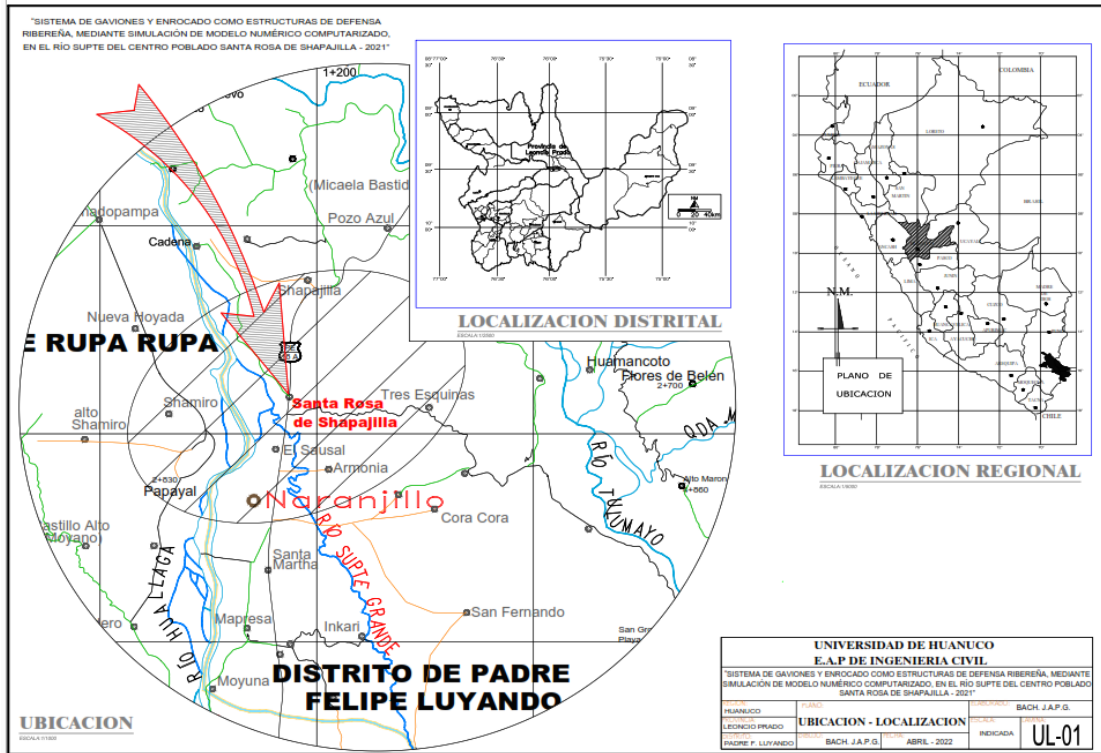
Vista en planta del área de estudio en el centro poblado Santa Rosa de Shapajilla.
